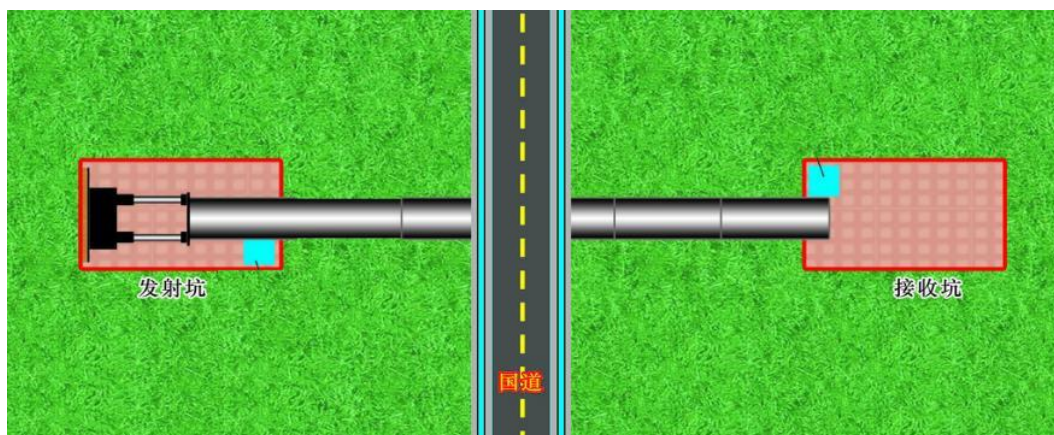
管道顶管穿越工程平面布置示意图(以公路为例)
